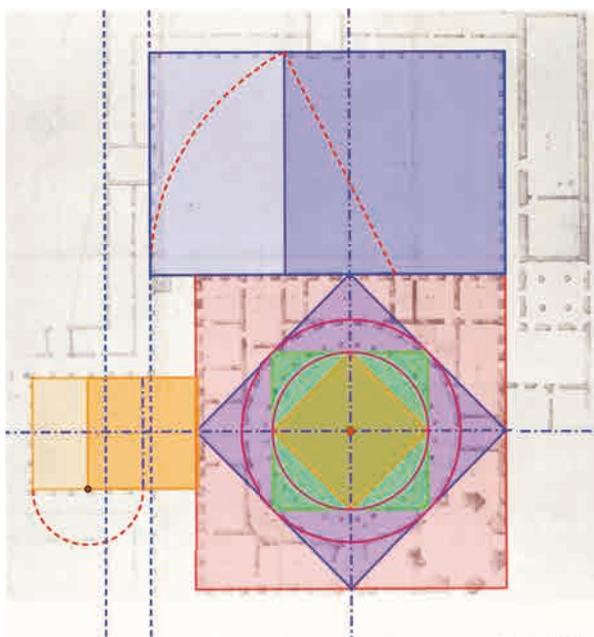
Geometría de los patios en la *Planta Pequeña*. Fuente: Elaboración propia sobre plano de Pedro Machuca de la Biblioteca Nacional. 1531.
